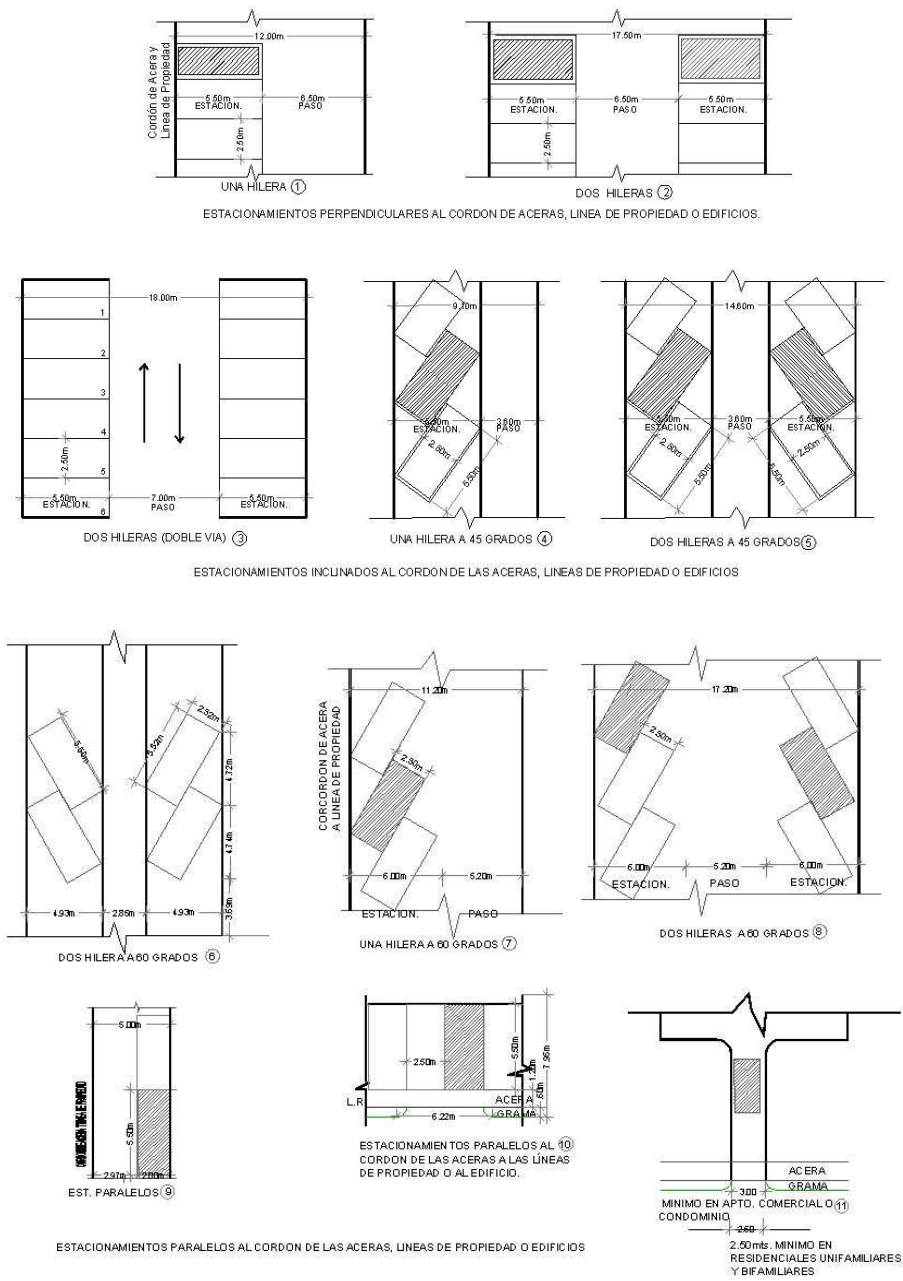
Detalles de estacionamientos. Fuente: Elaboración propia
